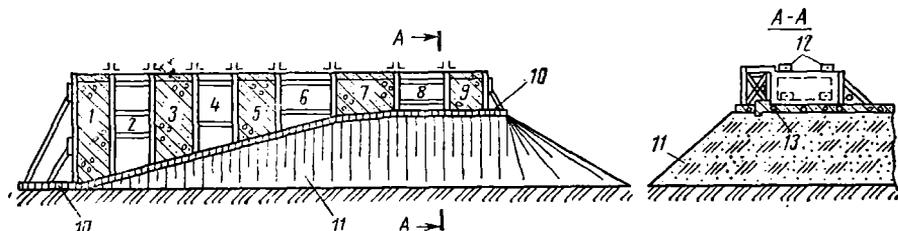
Стенд для изготовления блоков консоли, члененной по длине: 1-9 — бетонизируемые блоки; 10 — бетонный поддон; 11 — насыпь; 12 — фиксаторы; 13 — паропроводные трубы
